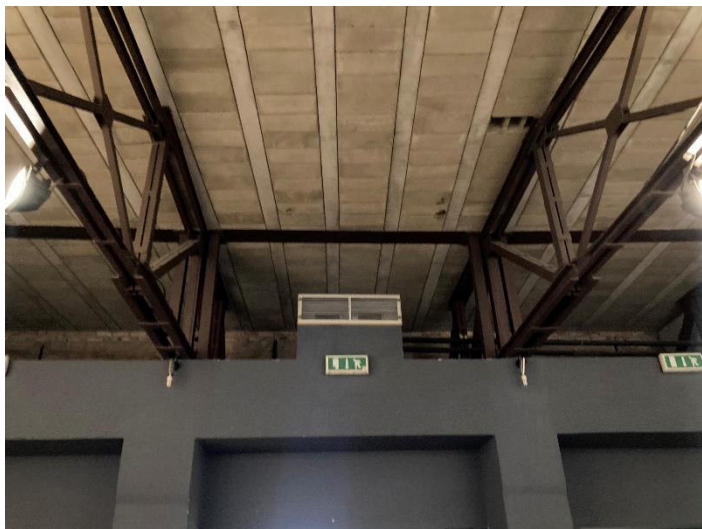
Solaio interpiano con elementi portanti in c.a. e blocchi forati di alleggerimento in calcestruzzo
